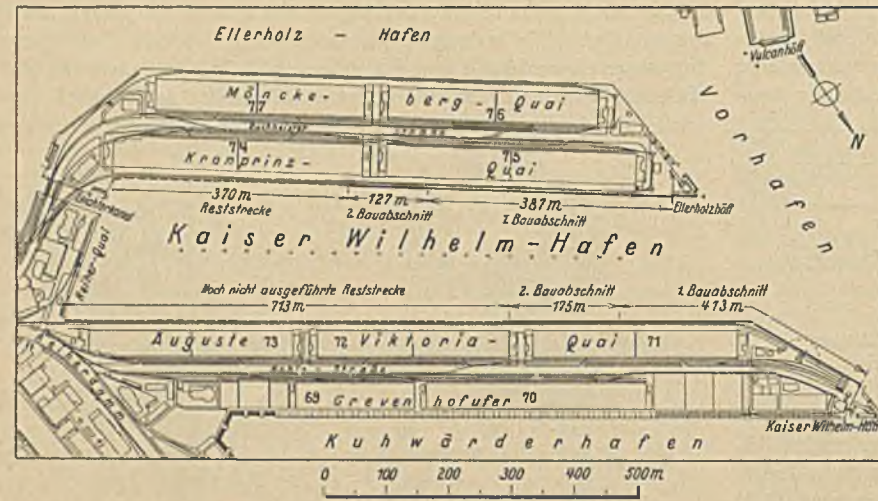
Lageplan des Kaiser-Wilhelm-Hafens mit den Bauabschnitten der Kaimauerverstärkung.
